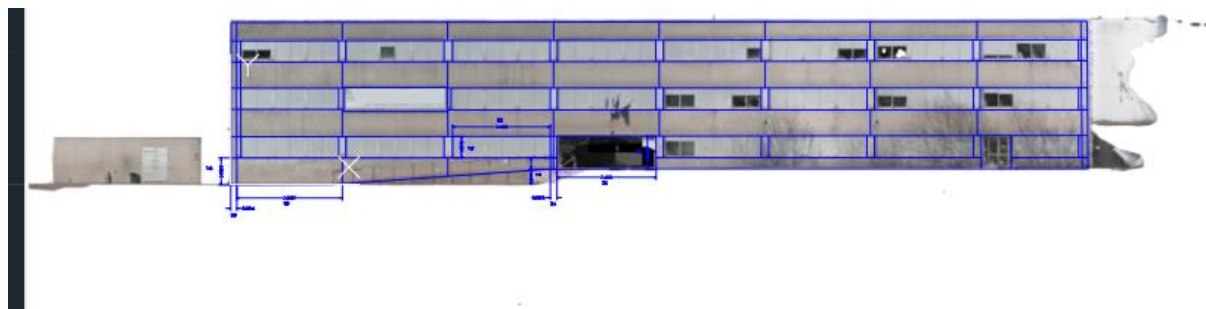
Prospetto della facciata sull'ortofoto del rilievo con il drone
